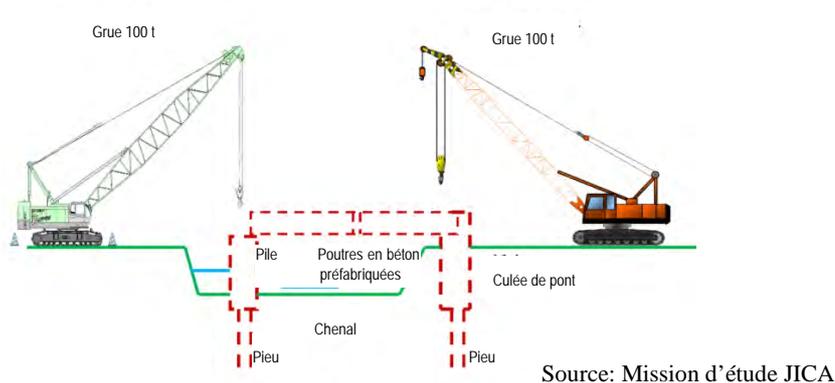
Procédé de pose des poutres en béton préfabriquées
